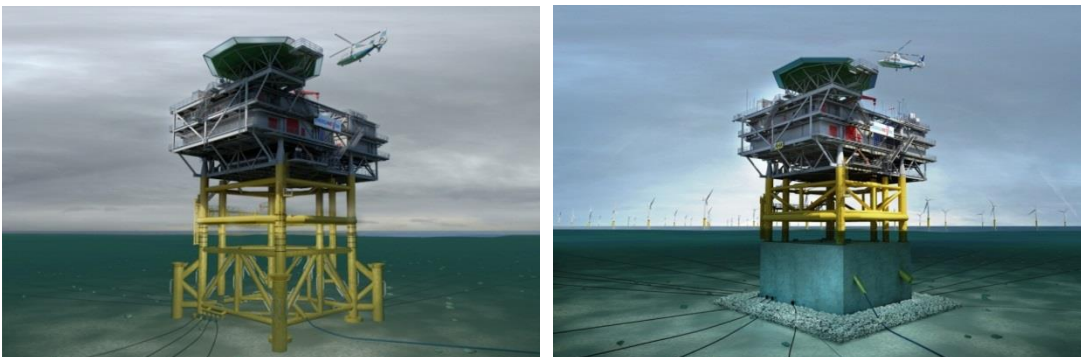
Til venstre: Principskitse af gravitationsfundament. Fundamentet til venstre består af et betonfundament fyldt med sand eller sten. På havbunden rundt om fundamentet er der etableret erosionsbeskyttelse af sten. Til højre ses et sugebøttefundament. Foto: Aalborg Universitet/Scanpix.
